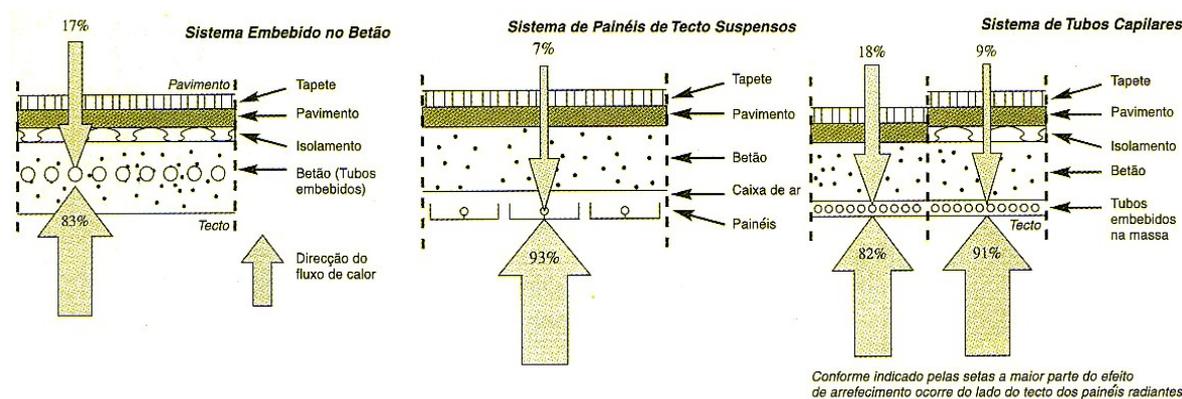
Integração arquitectónica dos sistemas de aquecimento/arrefecimento radiante (adaptado de Green Vitruvius).
